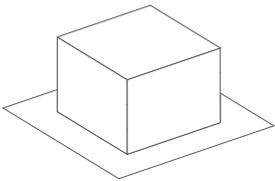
Zulässige Dachformen „Gemeinschaftsschiene“, „Waldpark“
